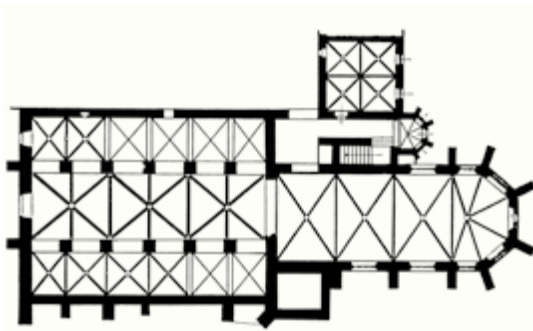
Grundriss der ehem. Minoritenkirche in Stein
